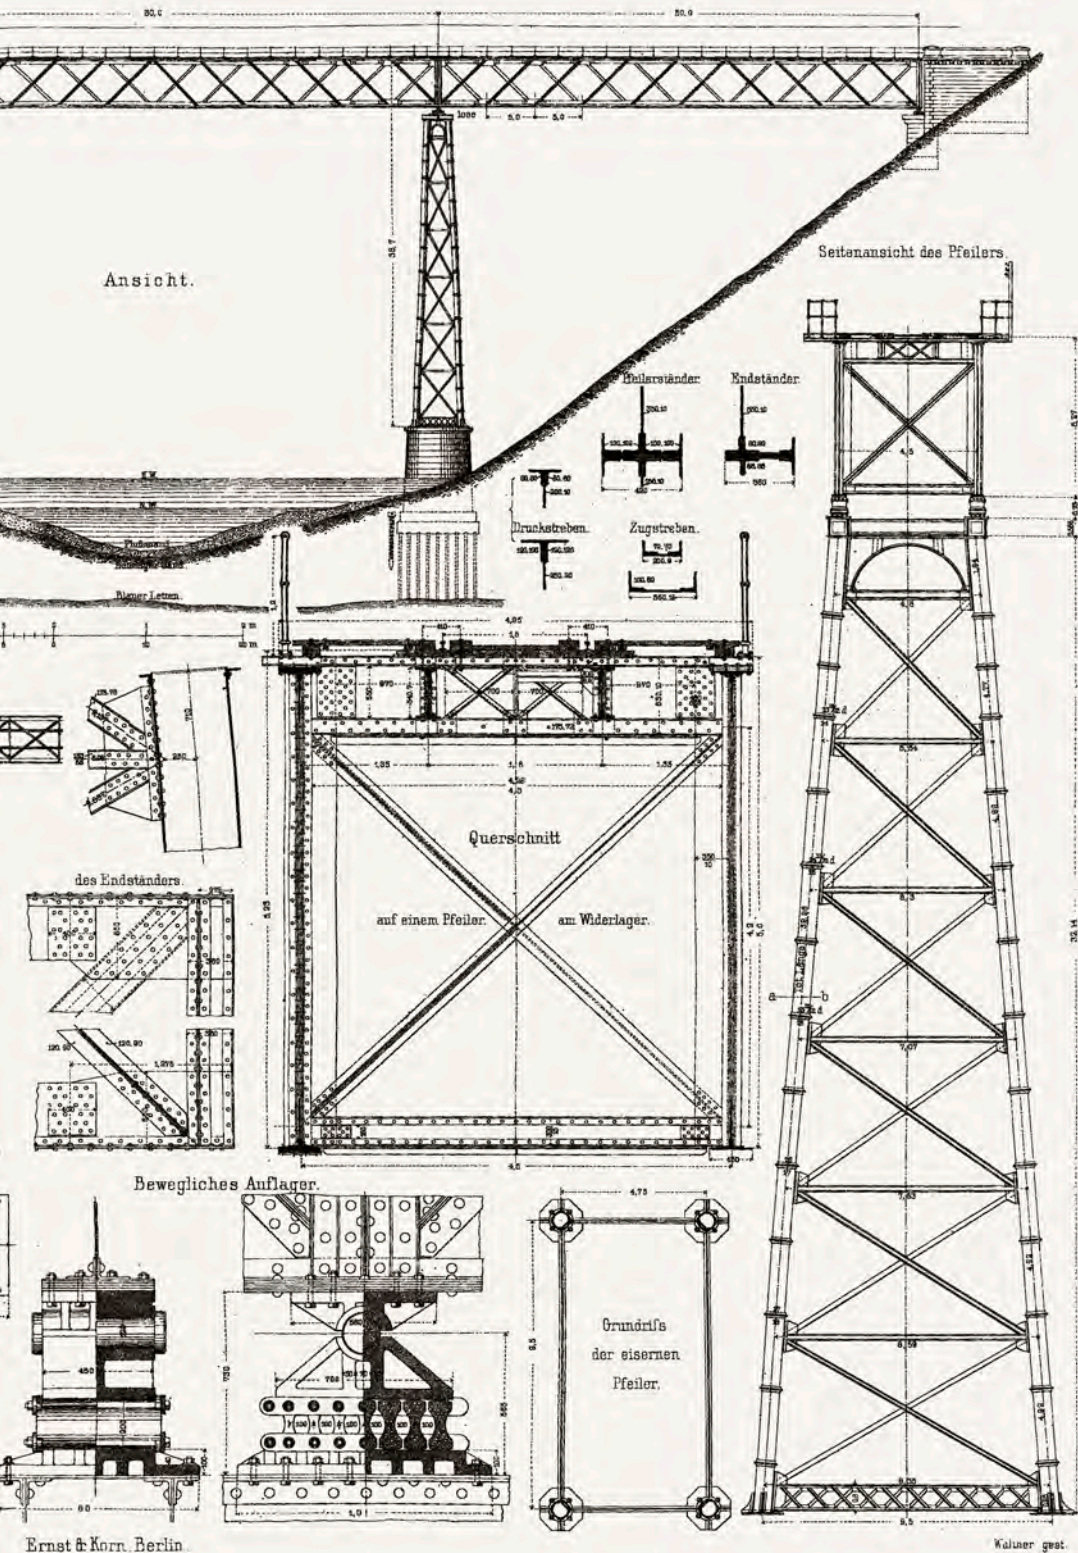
Plans du pont sur la Reuss de Mellingen (O. Riese, *Die Ingenieur Bauwerke der Schweiz*, 1887)
